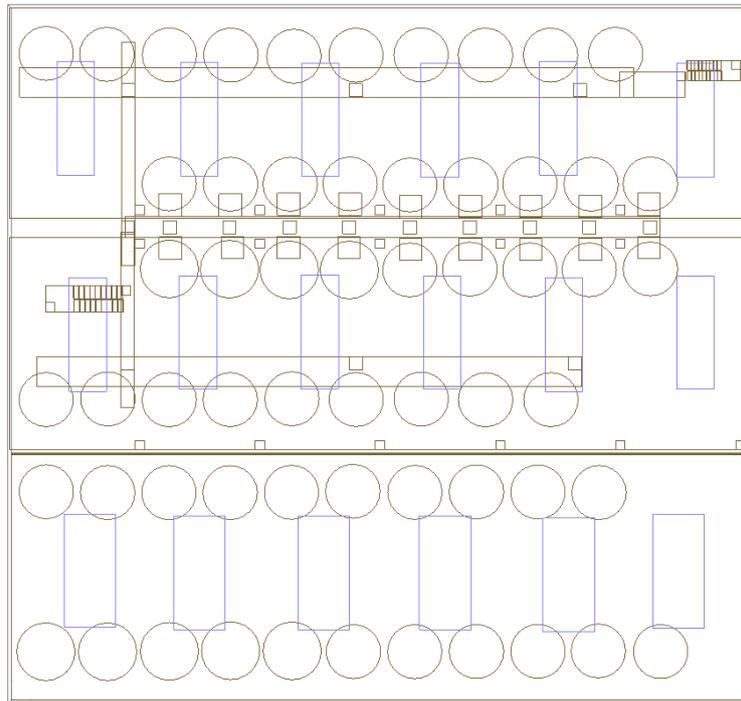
Vista en planta del almacén con los lucernarios de la propuesta 1. Fuente: DIALux.
